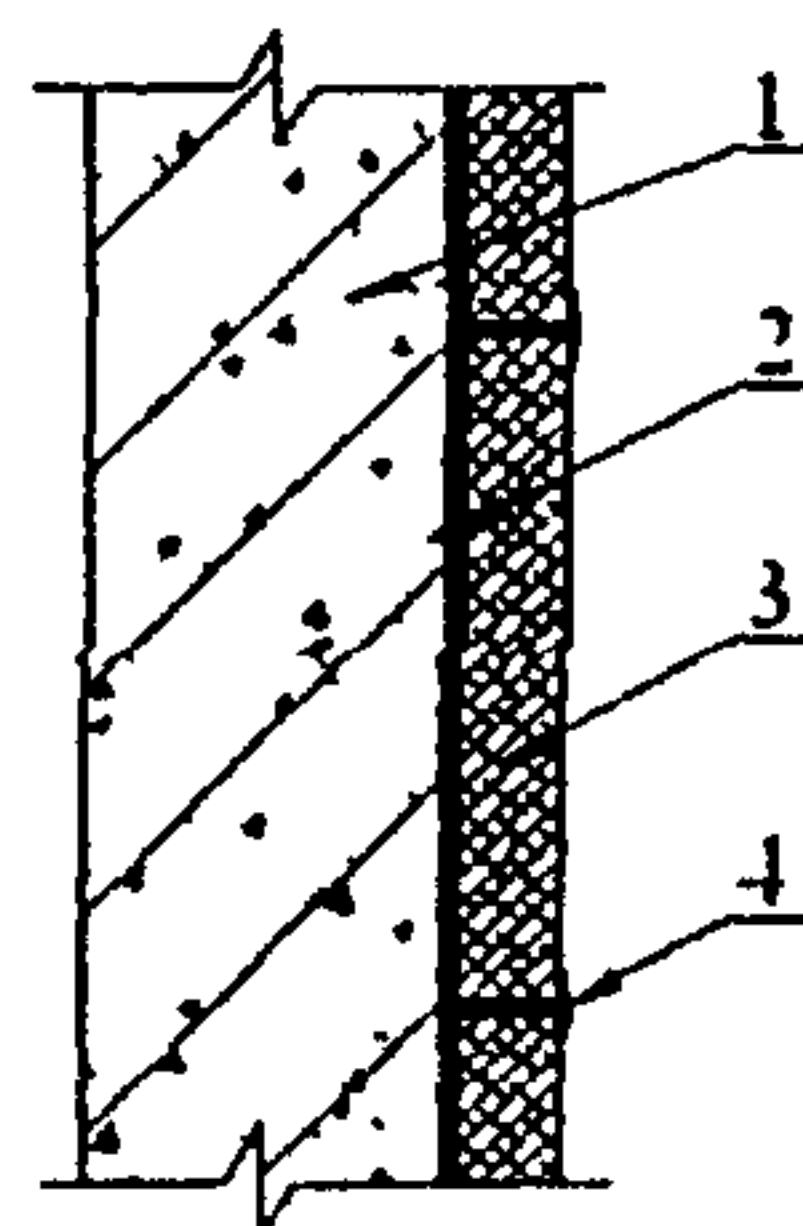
Аппликация железобетонных и металлических конструкций листами из материала ТФ-1-ВП:
